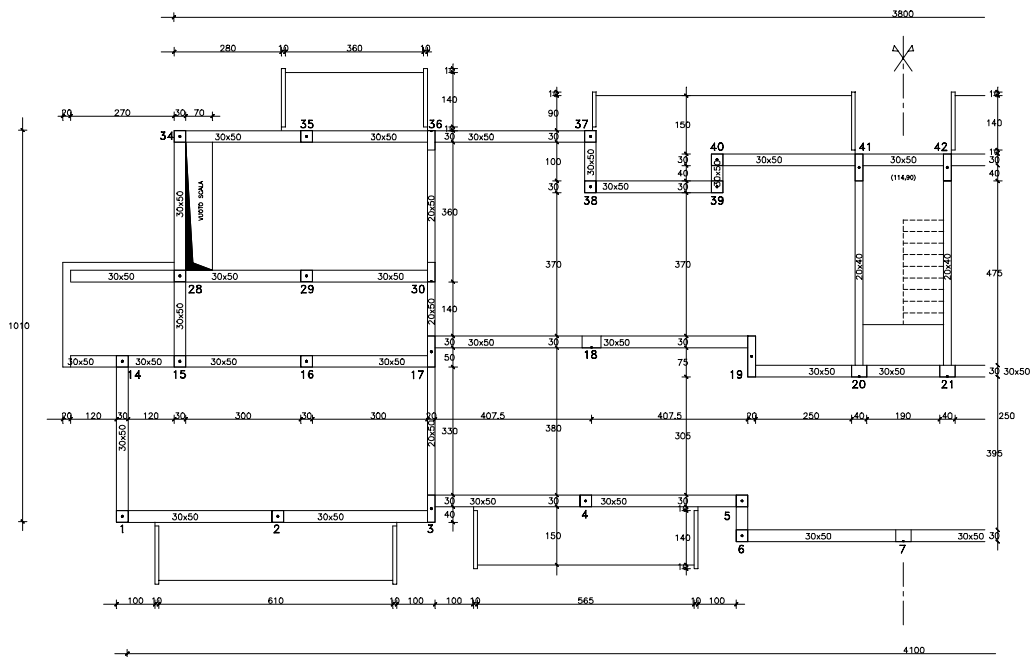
Edificio di quattro piani: pianta piano tipo.
